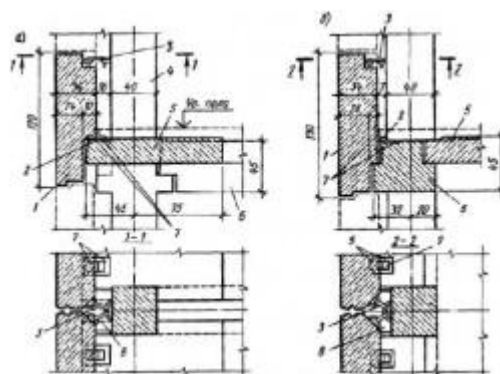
Опираие наружных стеновых панелей каркасных зданий:
